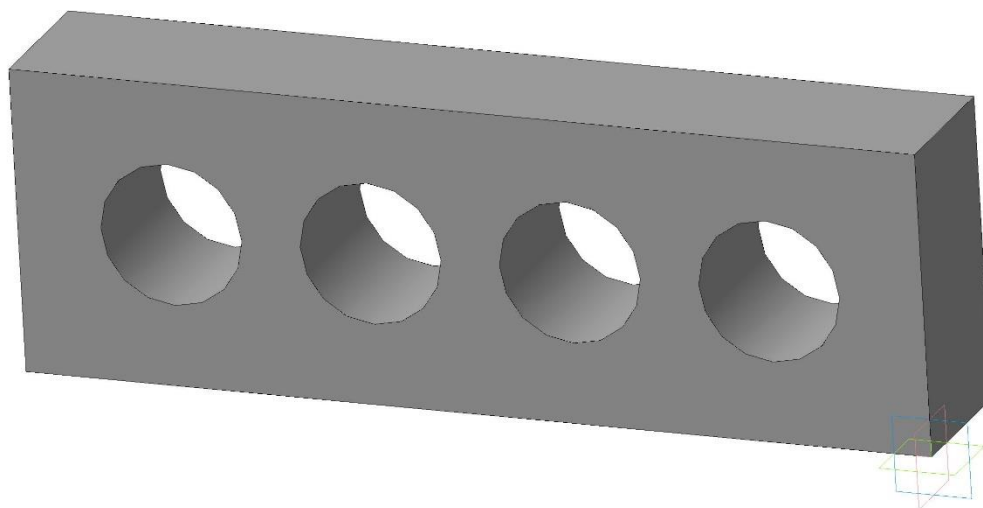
Газобетонний блок з колоподібними отворами діаметром 90 мм
